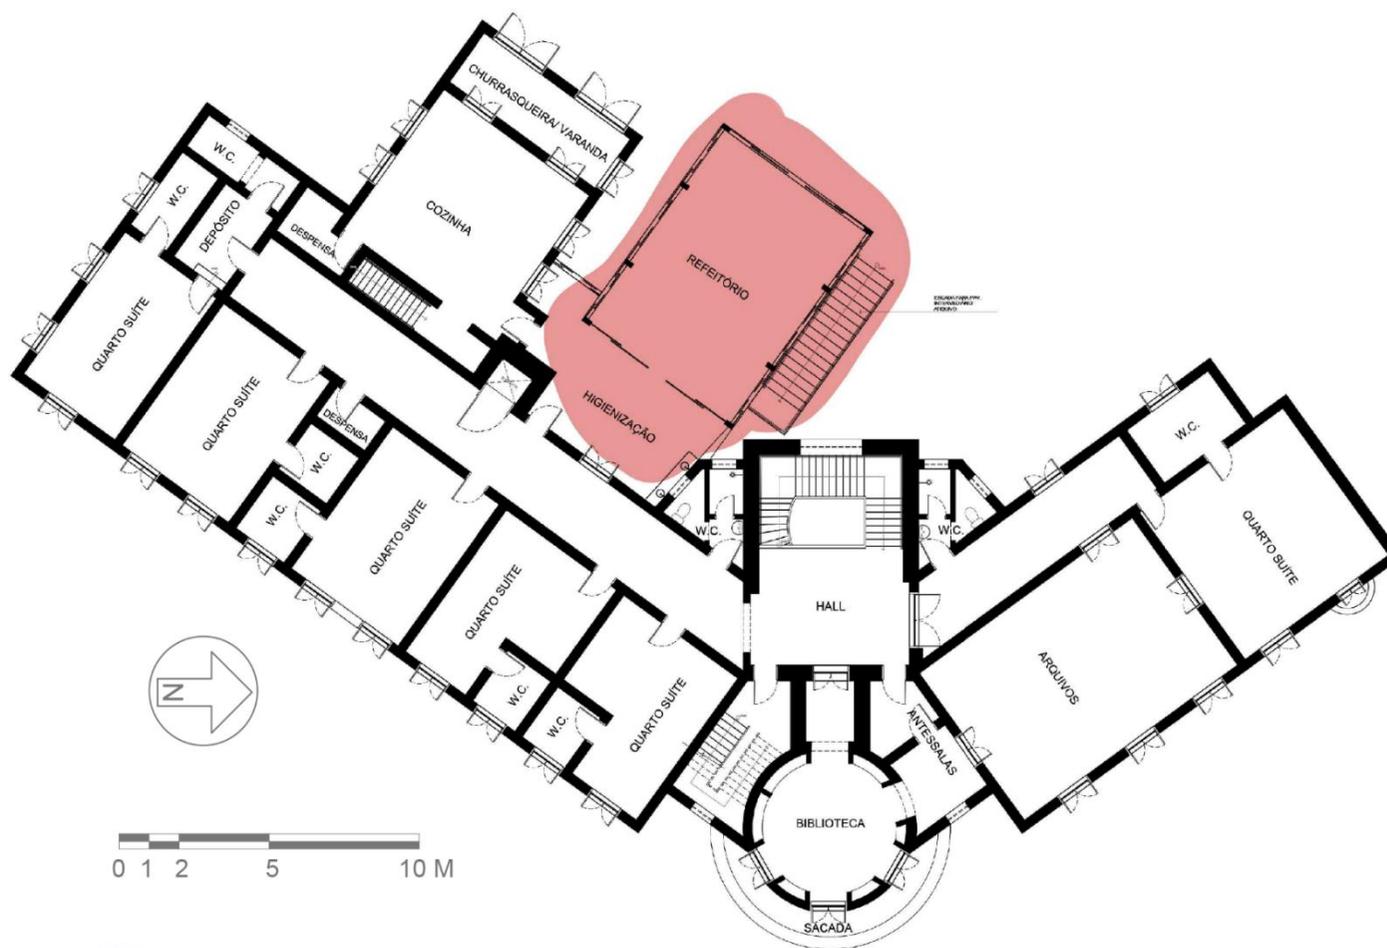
Planta do 2º Pavimento com ampliação destacada em vermelho.
